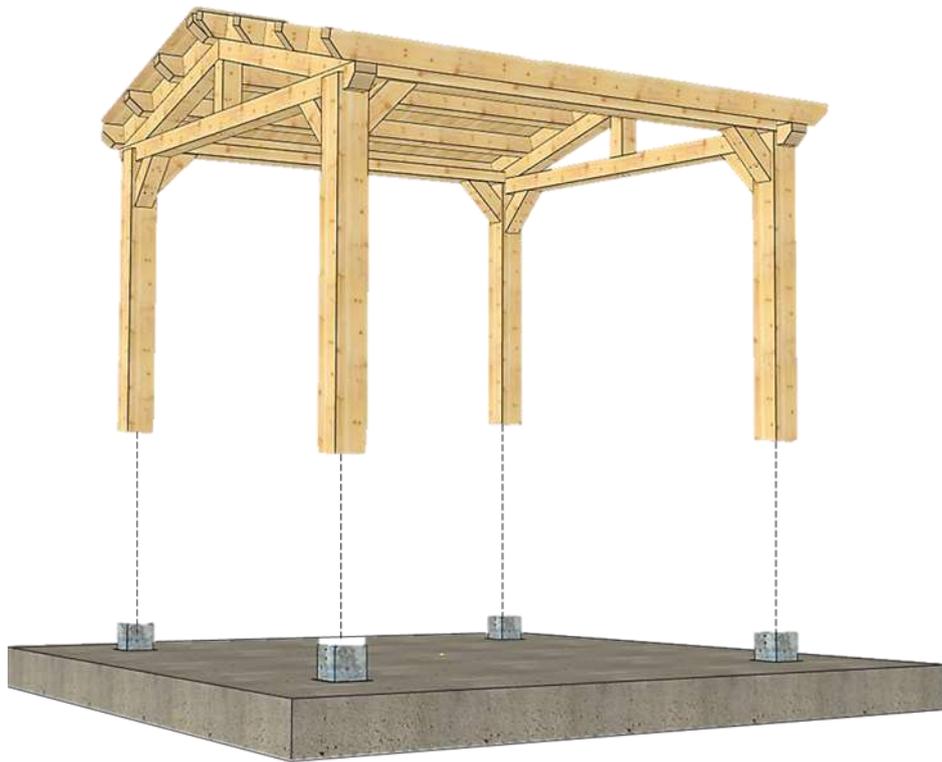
Representación de la instalación de la estructura de abeto laminado a la solera de hormigón mediante los soportes diseñados para tal fin. Fuente: Elaboración propia
